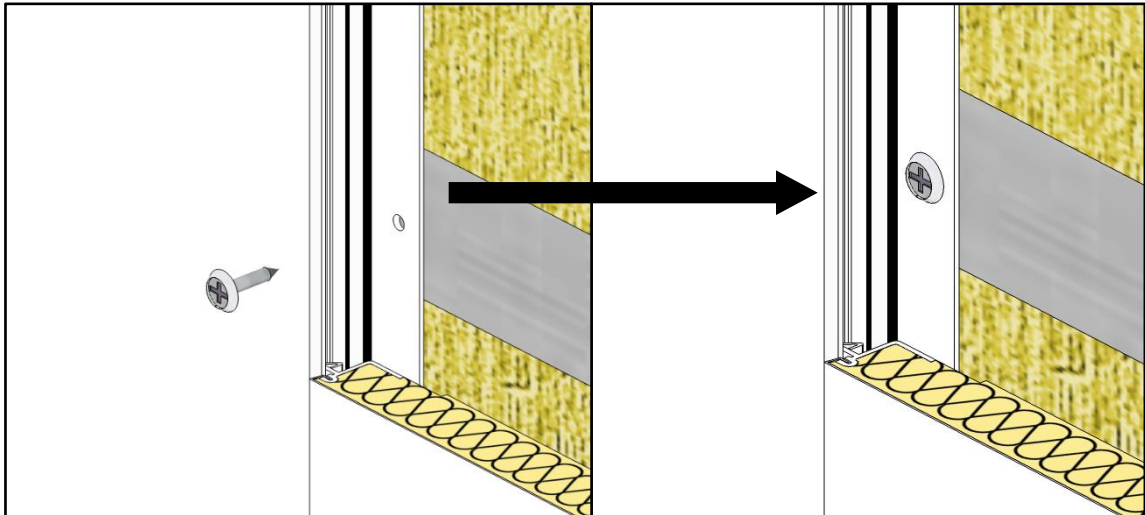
Principe d'emboîtement et fixation cachée des panneaux MYRAL
